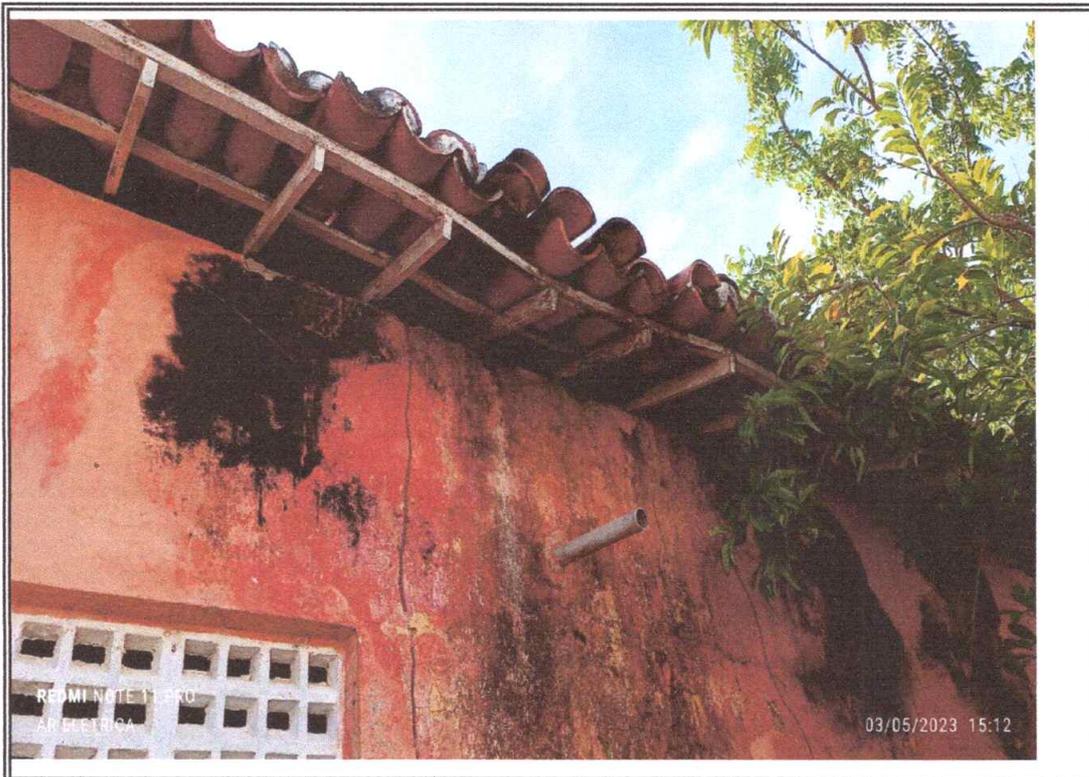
Vista das telhas, onde será realizado o retelhamento
